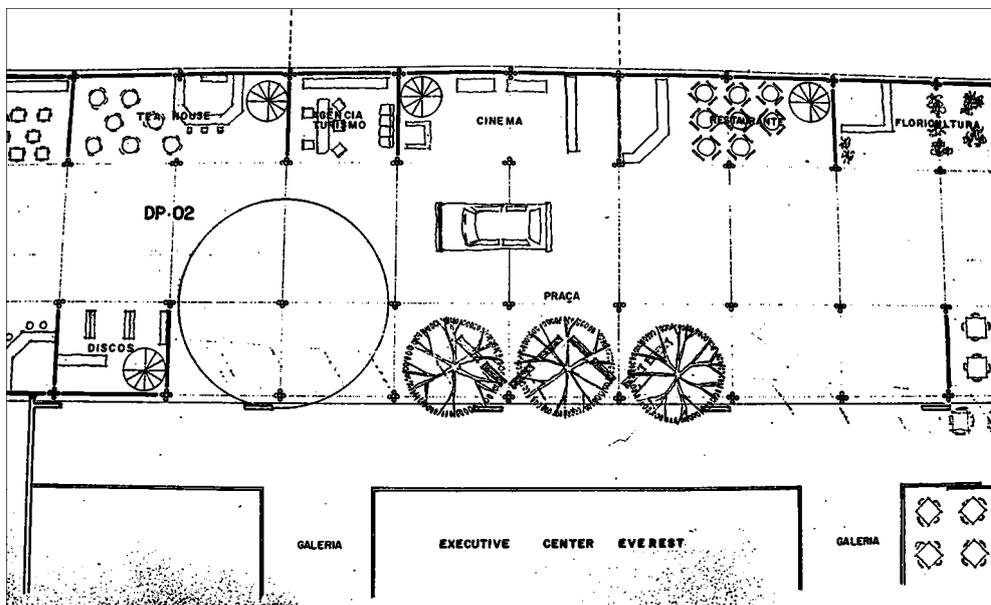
Trecho da planta original mostrando conexão com Centro Everest. (FONTE: Acervo IPPUC, 2009)
